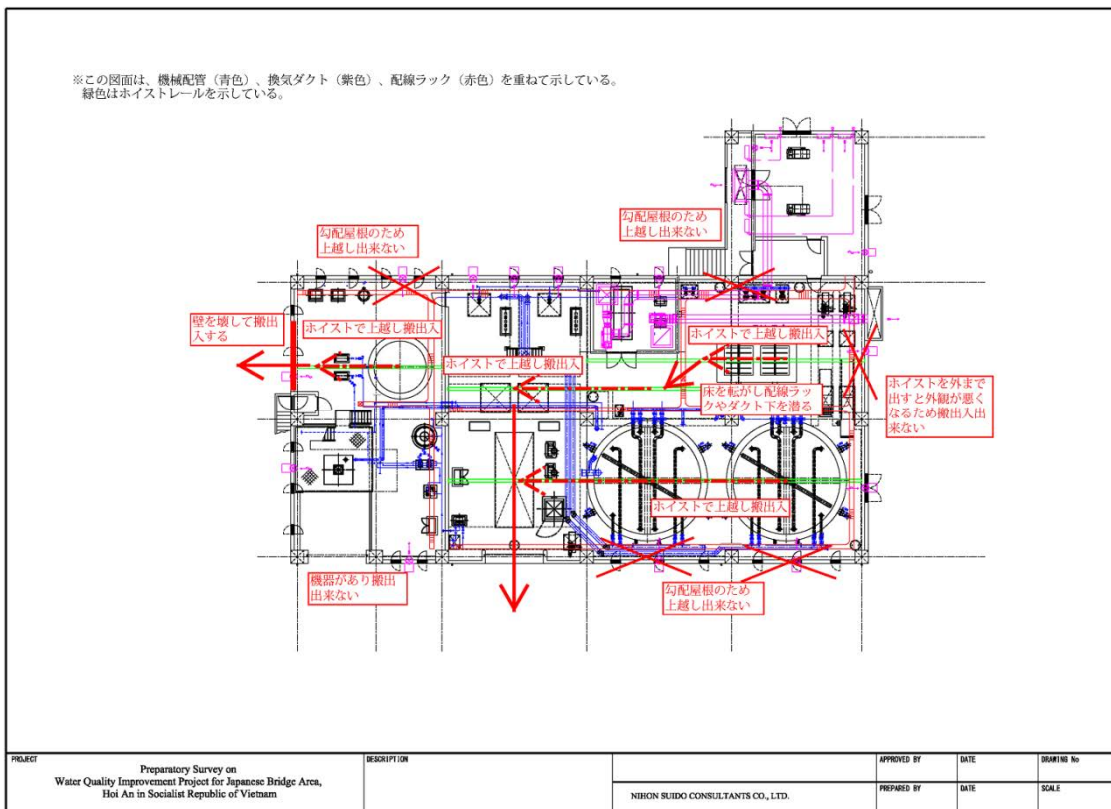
コンクリート製タンクの機器搬出入ルート（平面図）
